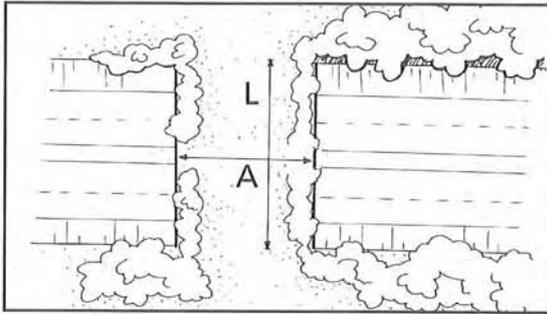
Terminología utilizada para definir la longitud (L) y la anchura (A) de un paso superior. En este manual la longitud y la anchura se definen desde el punto de vista de los animales que utilicen el paso.
